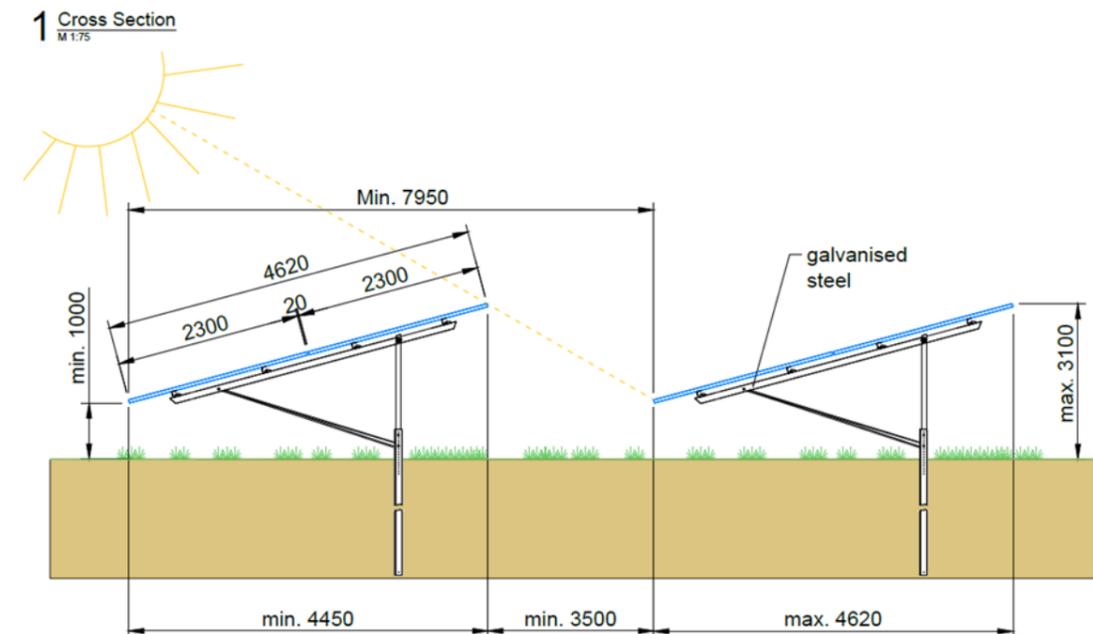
Plan de profil des structures de la centrale (source : ib vogt)
